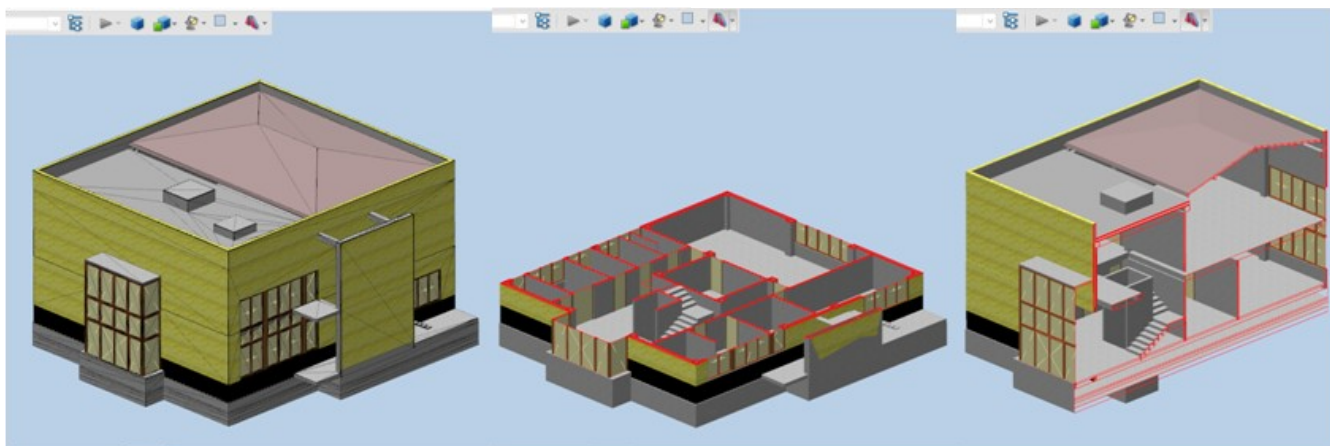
Modelado del edificio, empleando el software BIM Allplan. Explorado en archivo 3D.pdf
